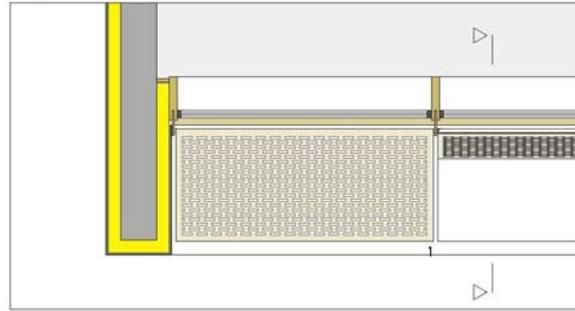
Fassadendetails Hückedahl Hildesheim Altbau M 1:50
